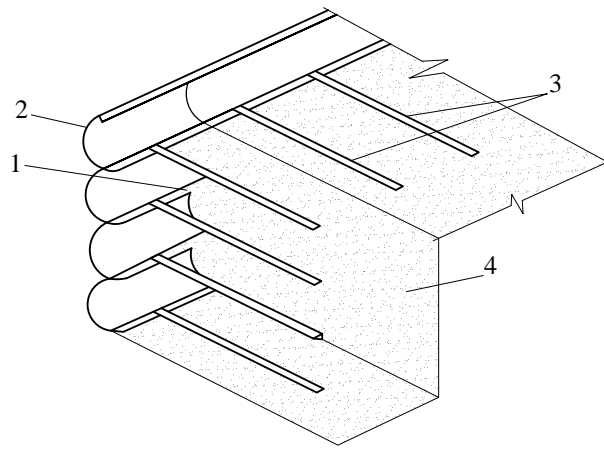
Армований масив ґрунту зі збірним металевим облицюванням: 1 – з’єднання у фальц; 2 – металевий елемент облицювання; 3 – армувальні елементи; 4 – ґрунт
